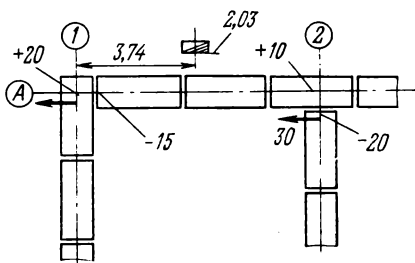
Схема исполнительной съемки фундаментов из блоков
